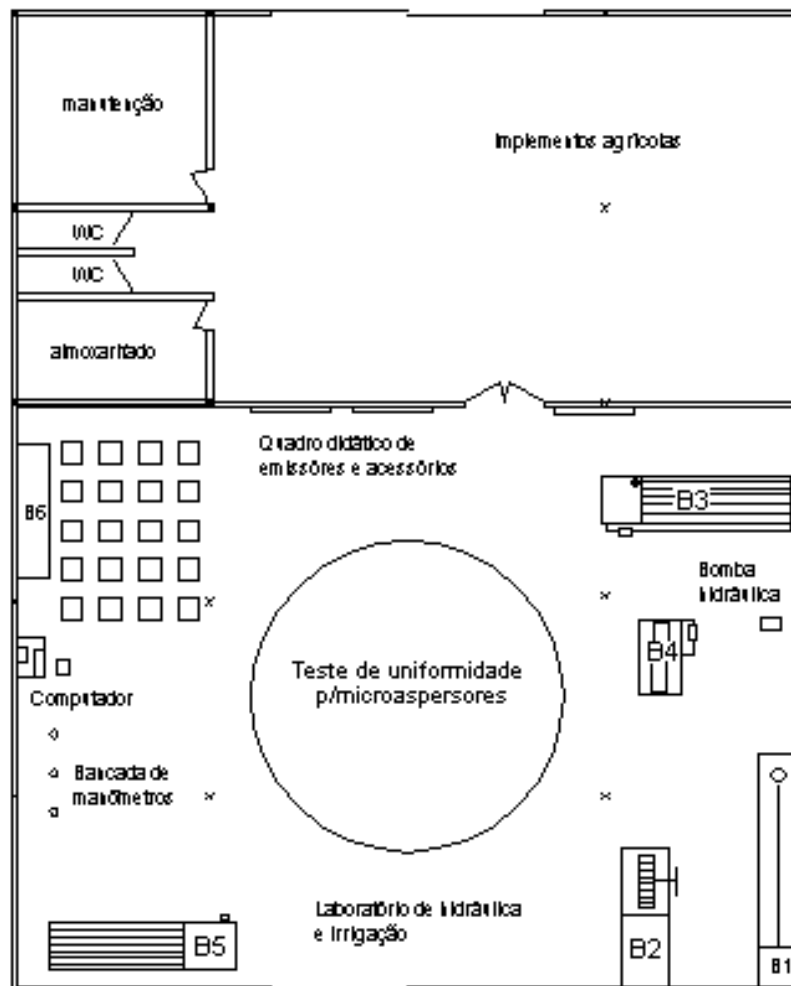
Layout do espaço físico e disposição das bancadas a serem construídas
